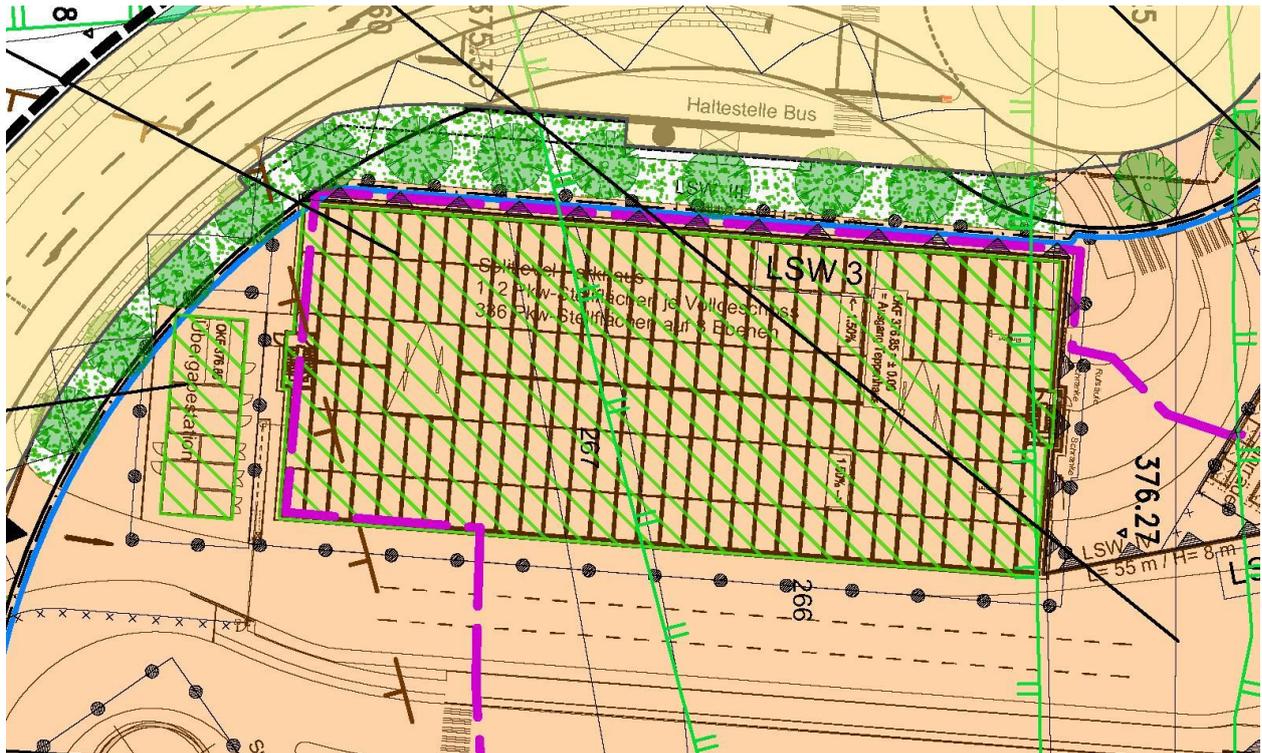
Baufelder Parkhaus und Übergabestation (nicht genordet)
